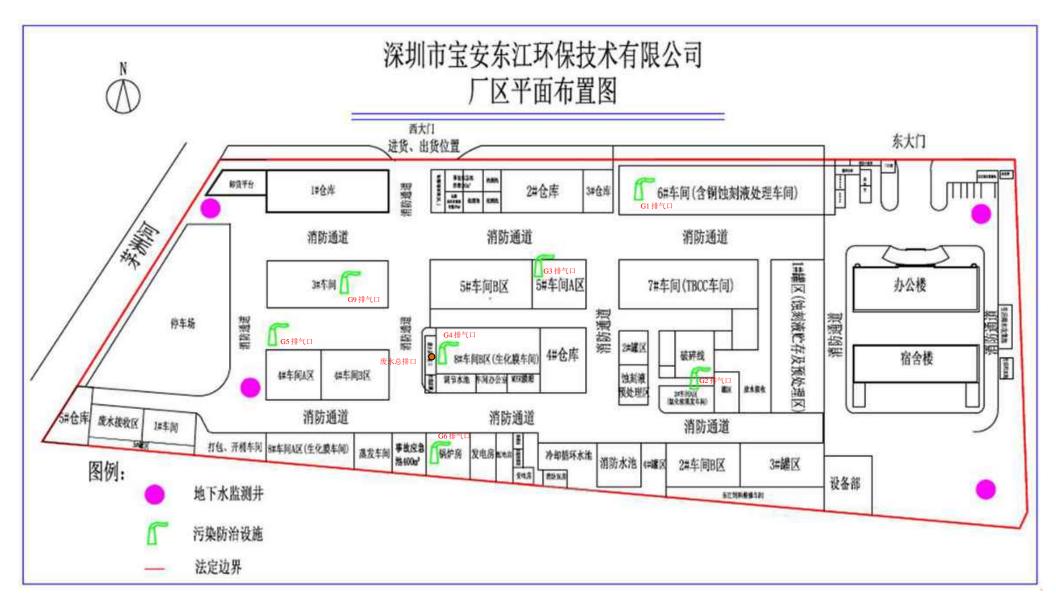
现有(改扩建一期)厂区总平面布置图
